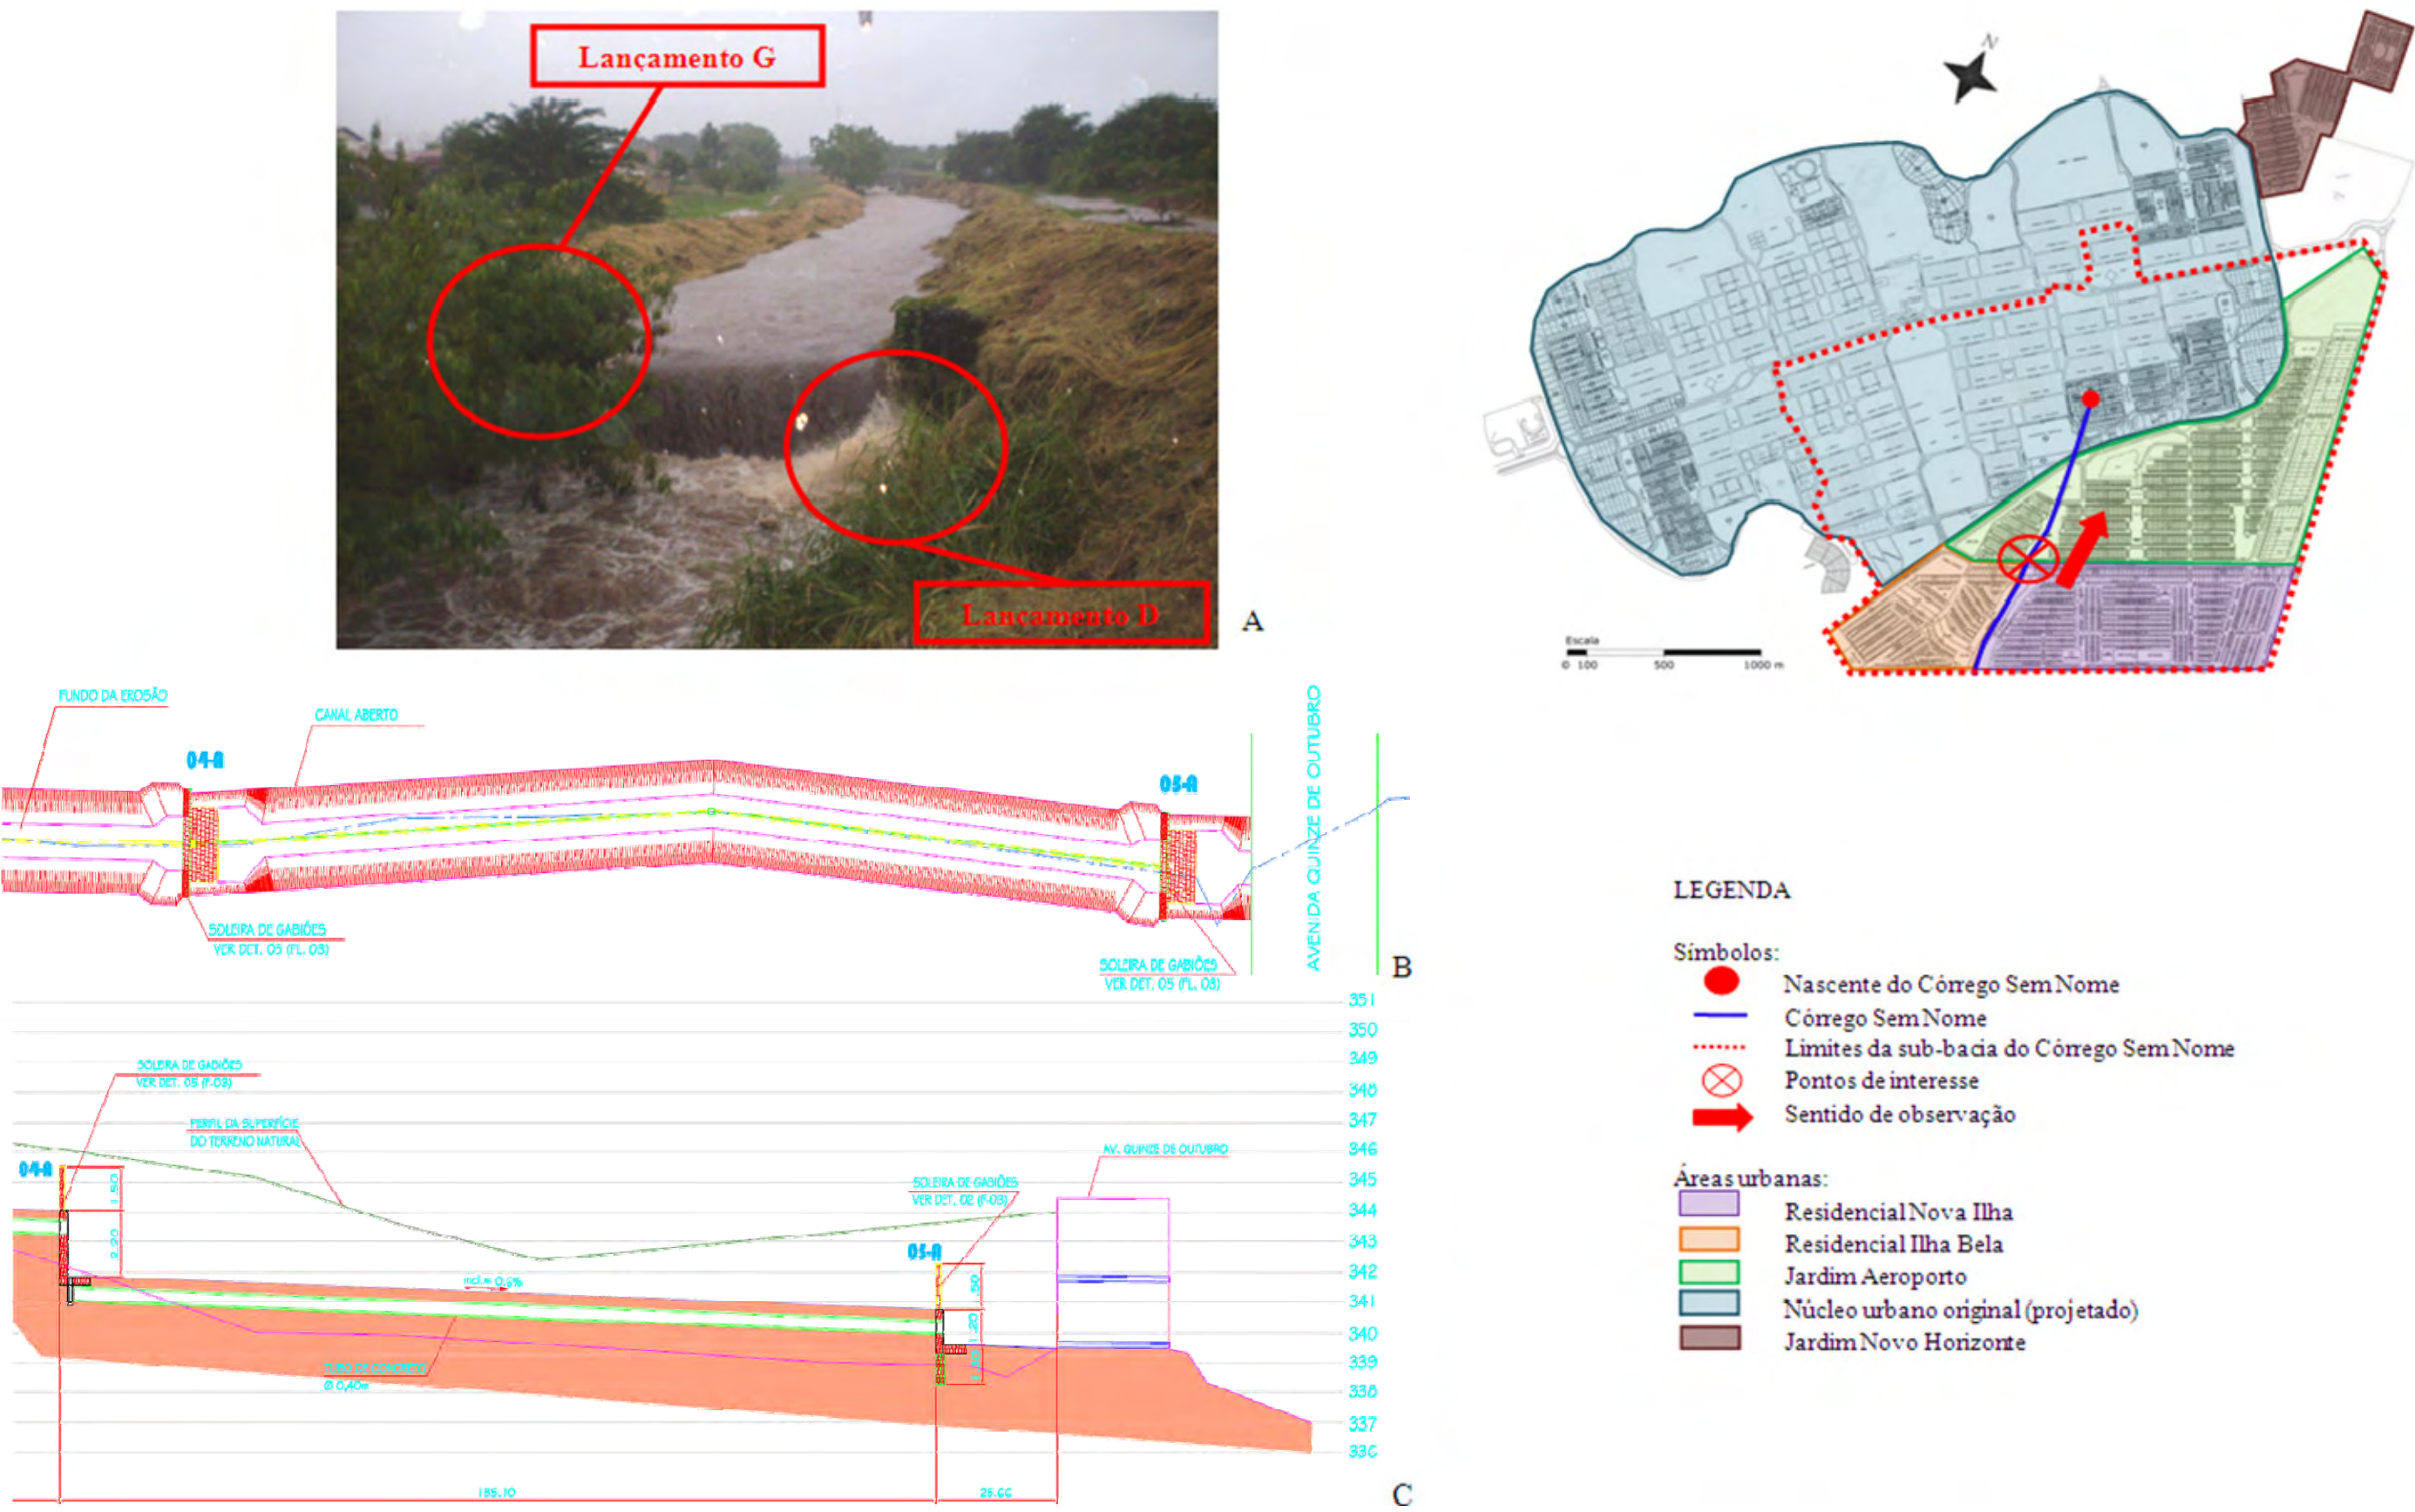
Foto do Trecho 3(A), perfil do Trecho 3 (B) e planta (C) (Fonte: (A) arquivo pessoal Thiago Santim, 16/05/2008; (B) e (C) Ilha Solteira, 2007)
